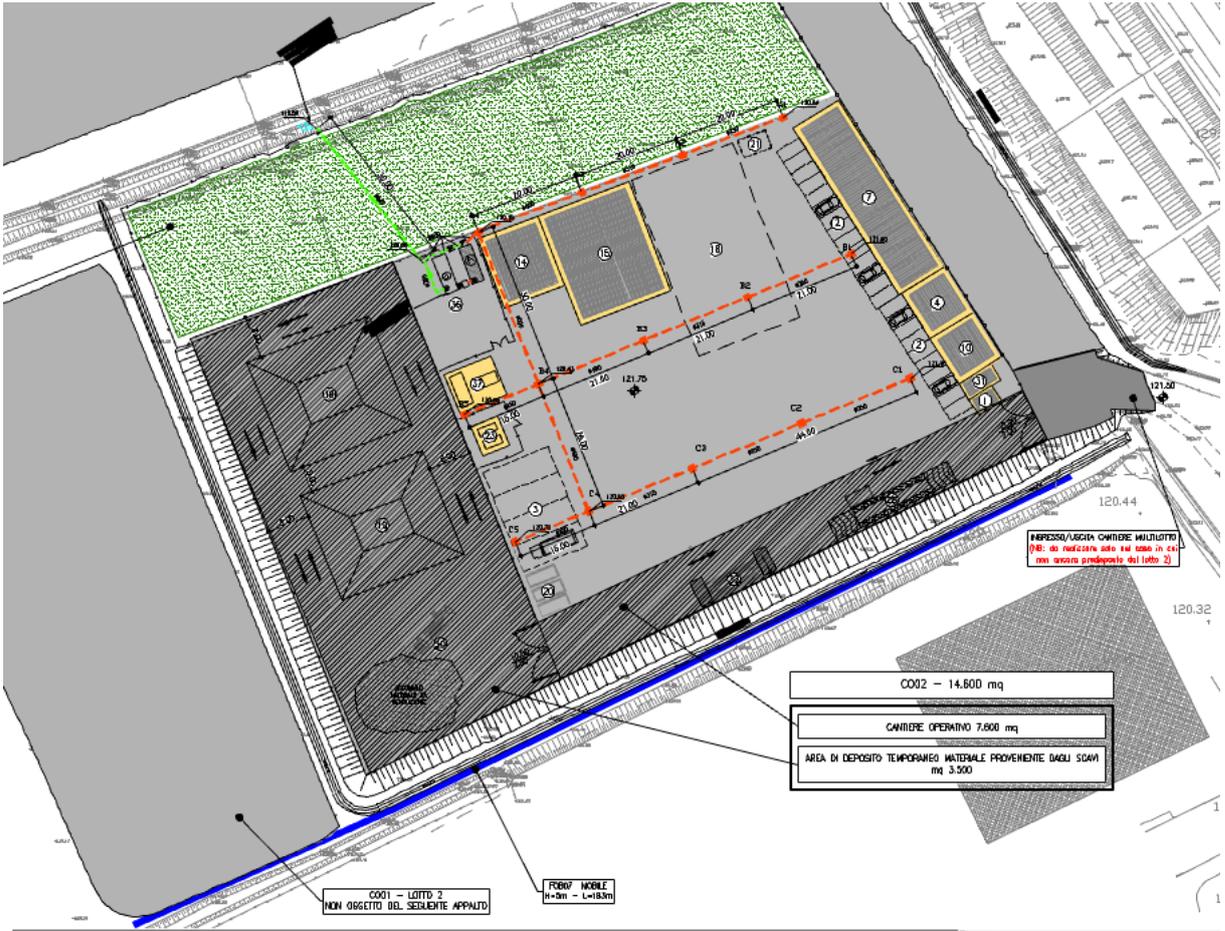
Planimetria reti idrauliche del CO02 – Cantiere operativo e area di deposito temporaneo terre
